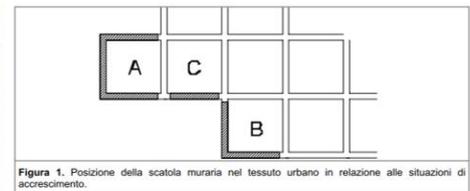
Posizione della scatola muraria nel tessuto urbano in relazione alle situazioni di accrescimento.
